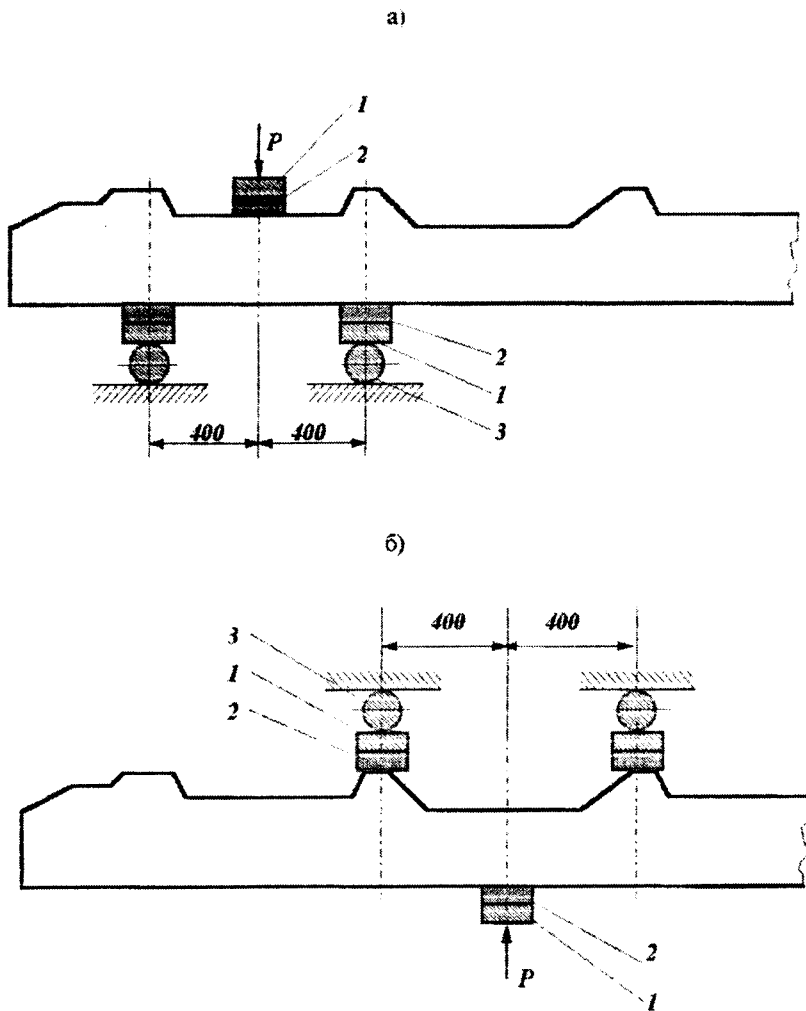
Схема испытаний бруса на трещиностойкость
